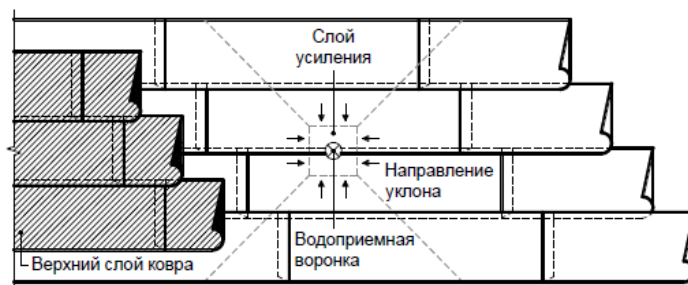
Раскладка полотнищ кровли в зоне водоприёмной воронки
